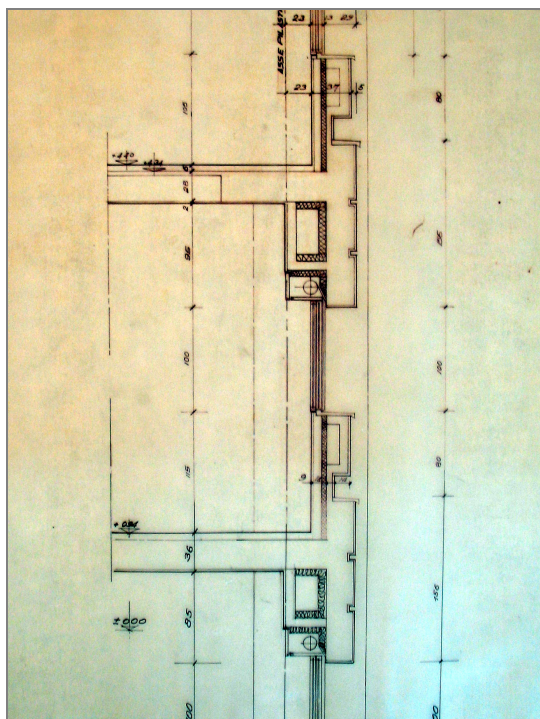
sezione corpo A – piano primo (fonte CSAC – stralcio tav. 37, archivio n. 400-1)
